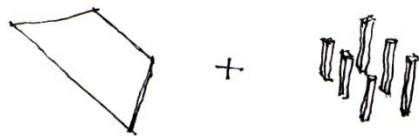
Système constructif à la première étape du concours : dalle massive et piliers en béton armé
